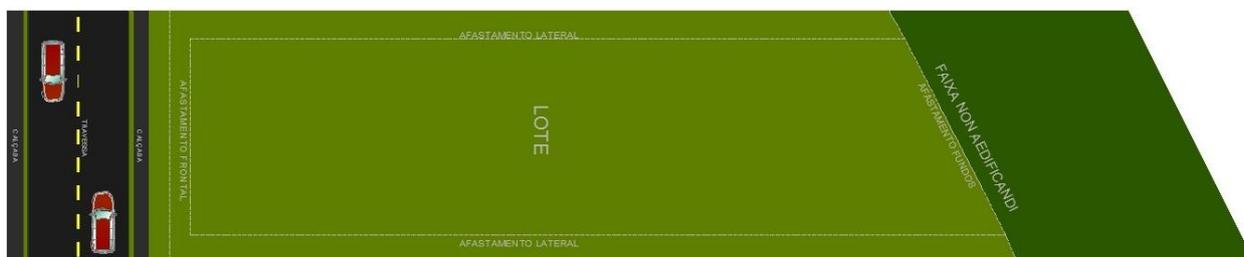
Definições e Restrições para Implantação (lote com faixa *non aedificandi*)
